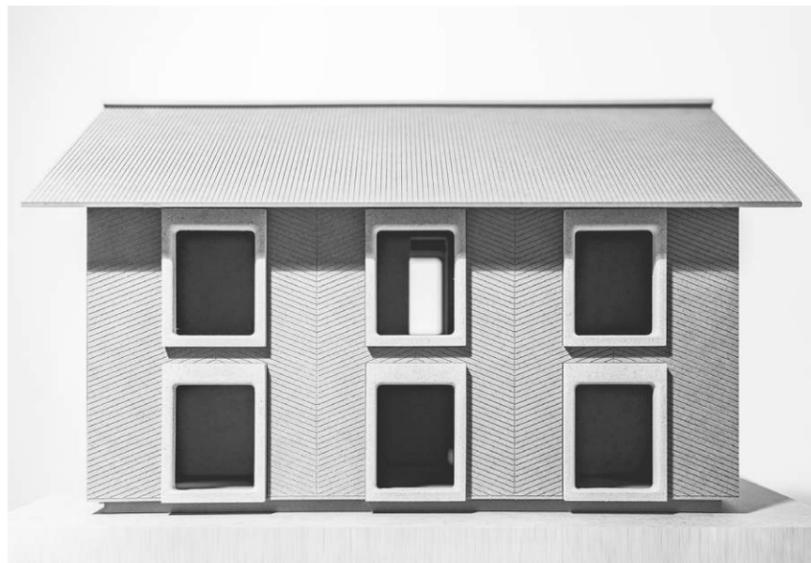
Fassadenkonzept, Lärchenholz mit dahinterliegender Hanfdämmung, Projekt Lehmhaus, Meißen, 2022
